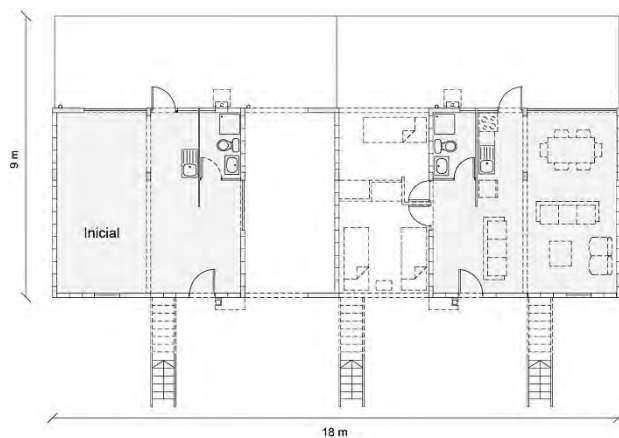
Casa en planta baja con *slack space*. Viviendas Quinta Monroy, 2003-2004
